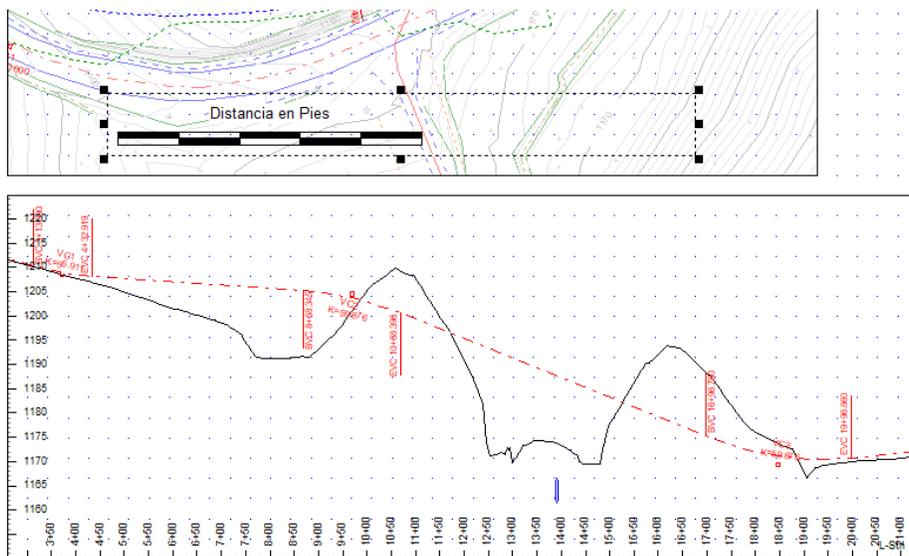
Barra de Escala en la Sub-vista de Planta
